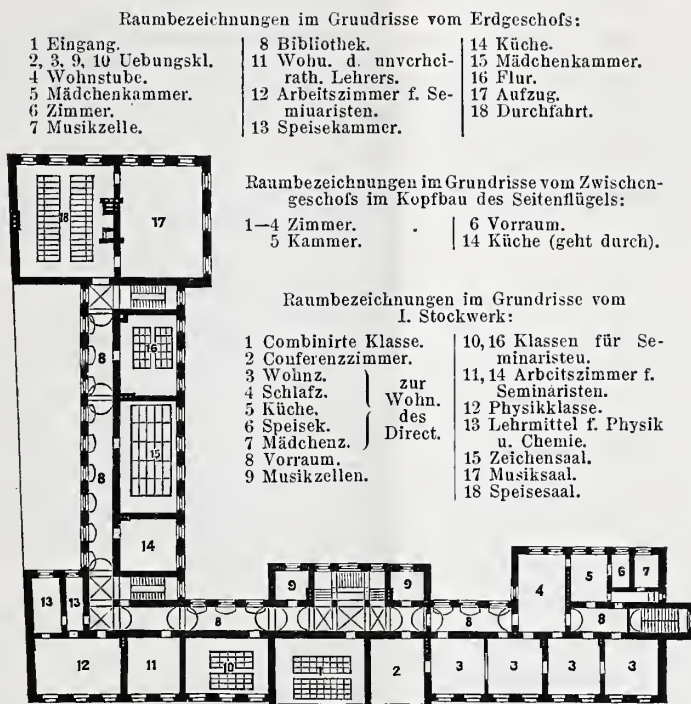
Grundriss vom I. Stockwerk.
